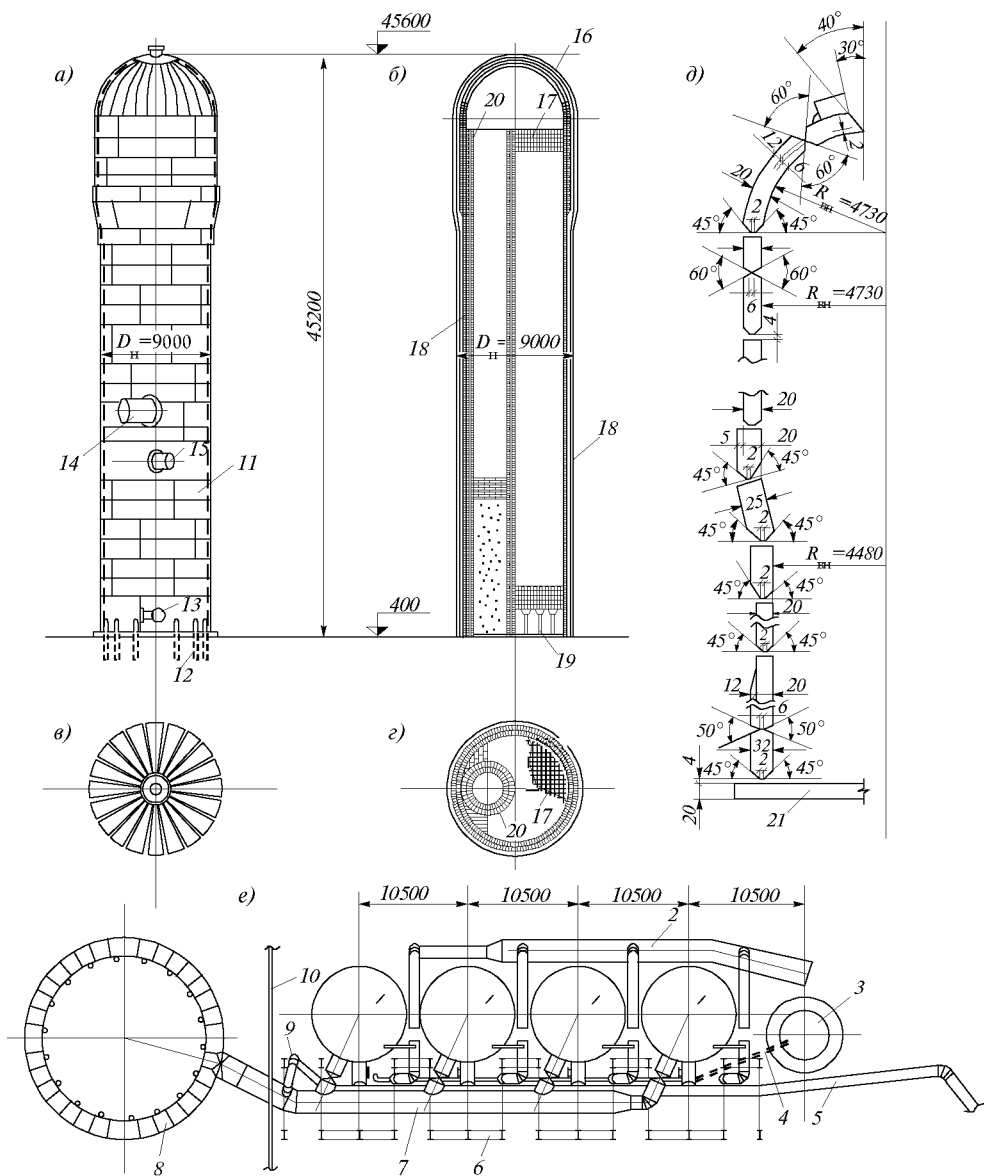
Планировка блока и конструкция воздухонагревателей большинства действующих доменных печей
